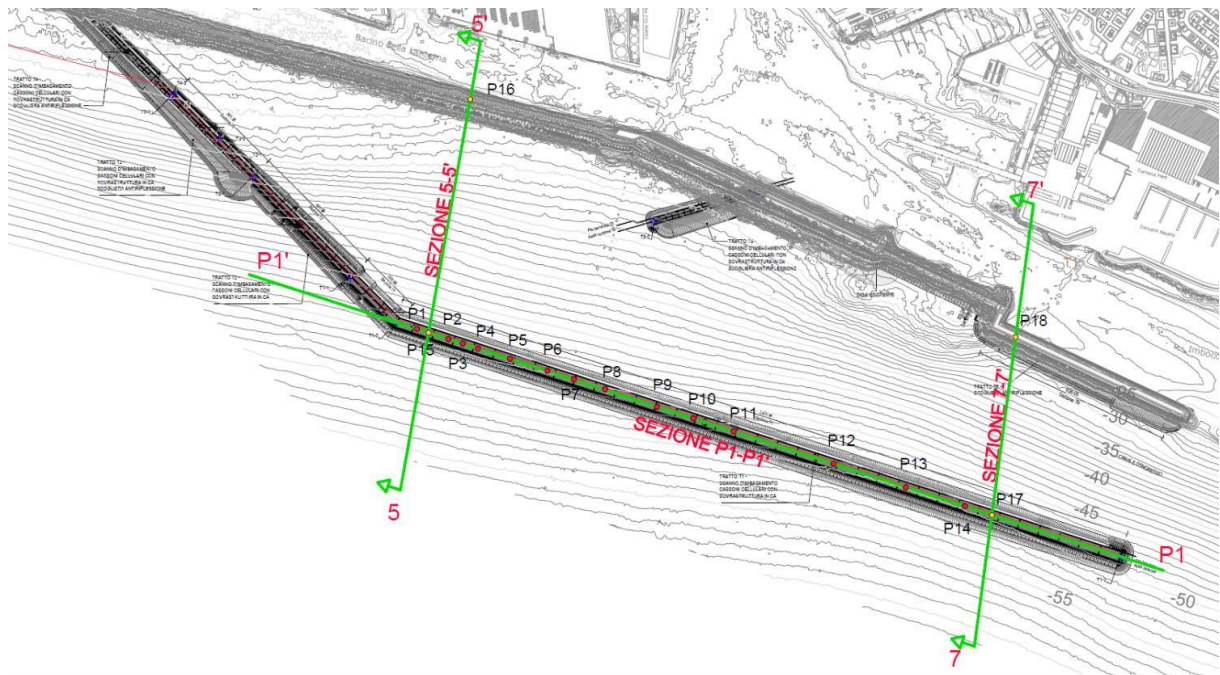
Traccia planimetrica delle sezioni di calcolo P1-P1', 5-5' e 7-7'
